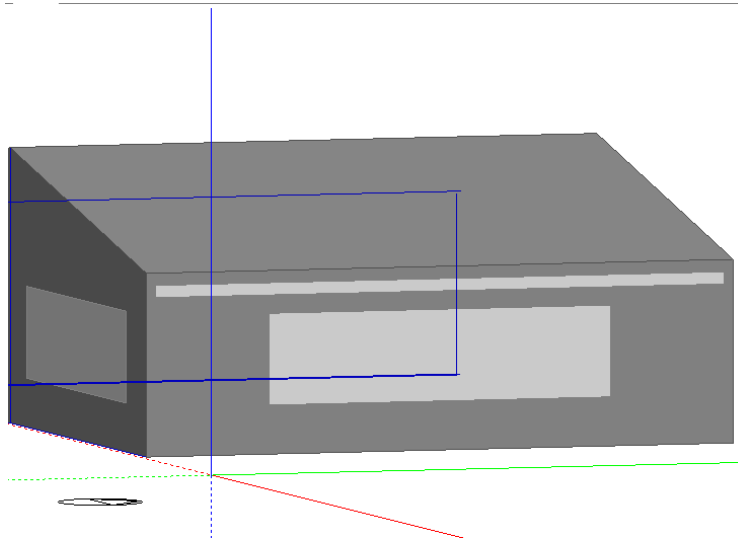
Imagen de fachada Sur, con la entrada de ventilación en la parte superior
